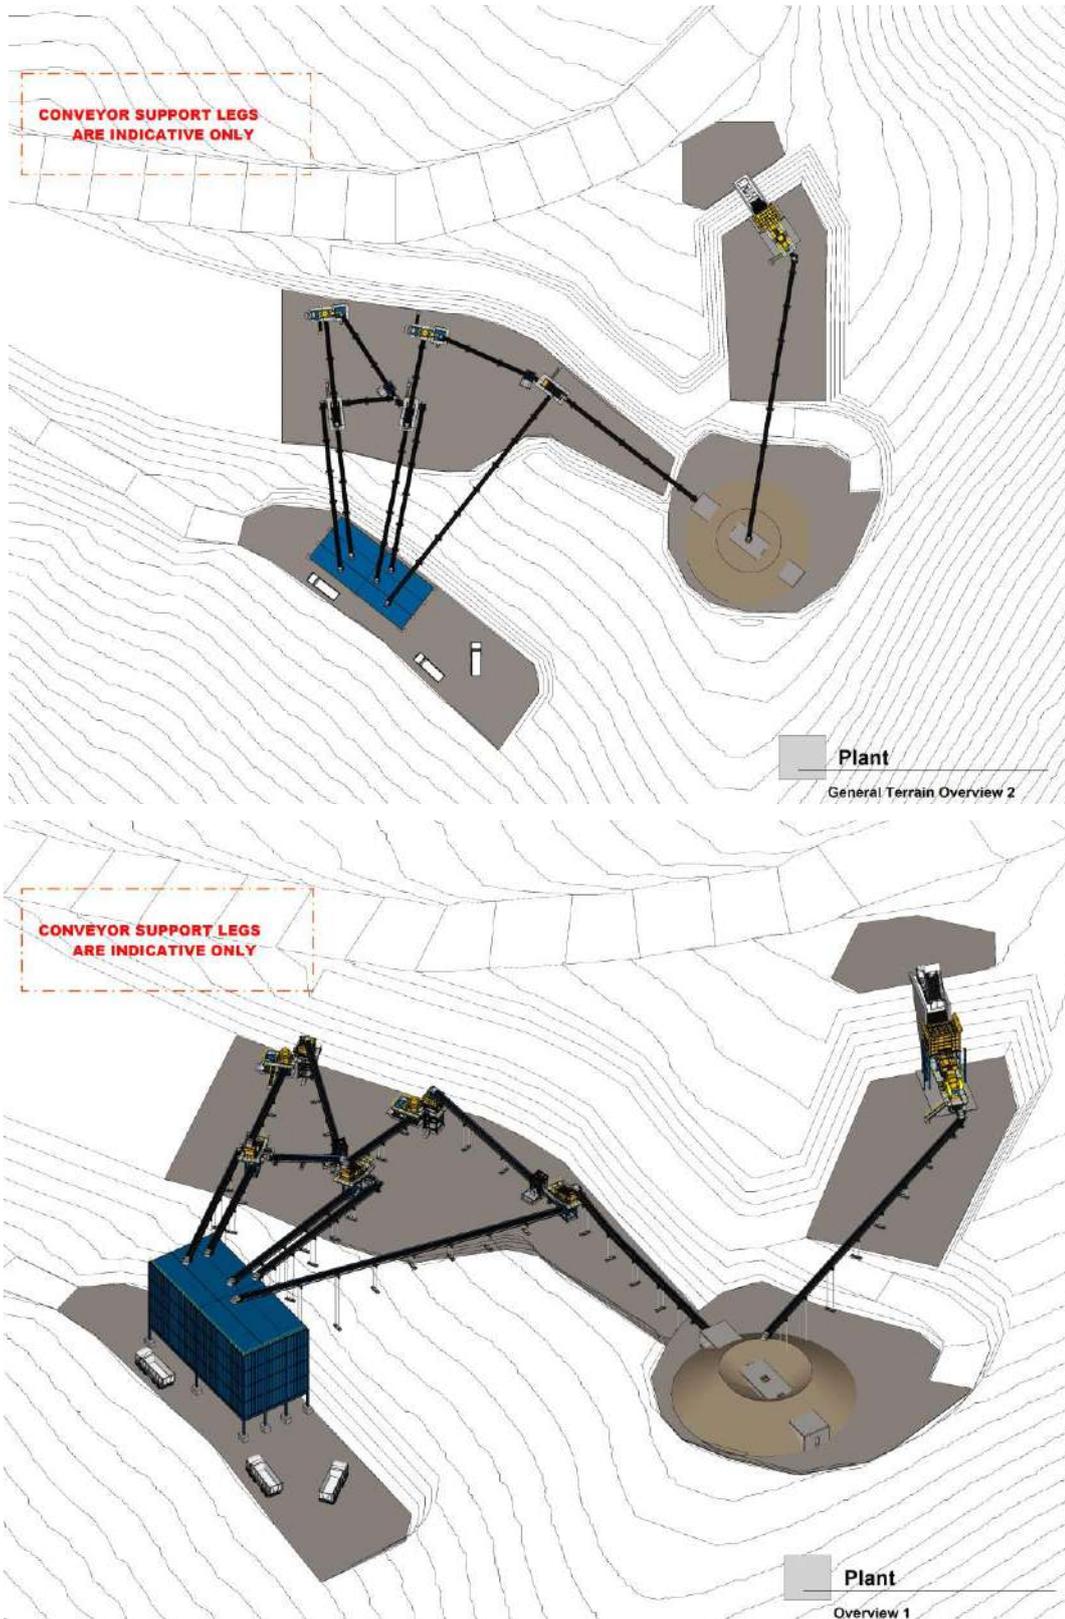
Vista en planta y 3D de la planta de tratamiento (Fuente WEIR Minerals)
